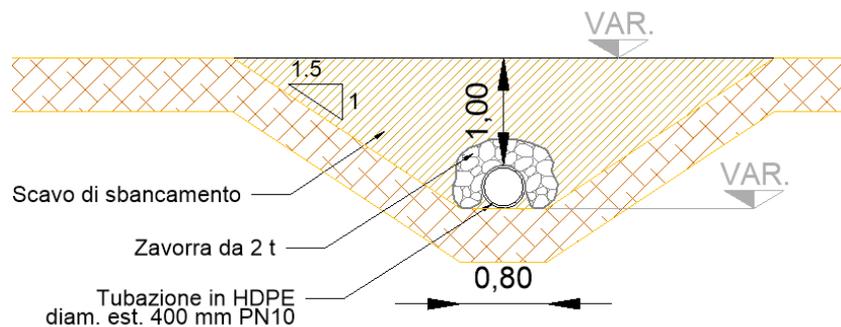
Sezione tipo trincea sabbiodotto con zavorra
